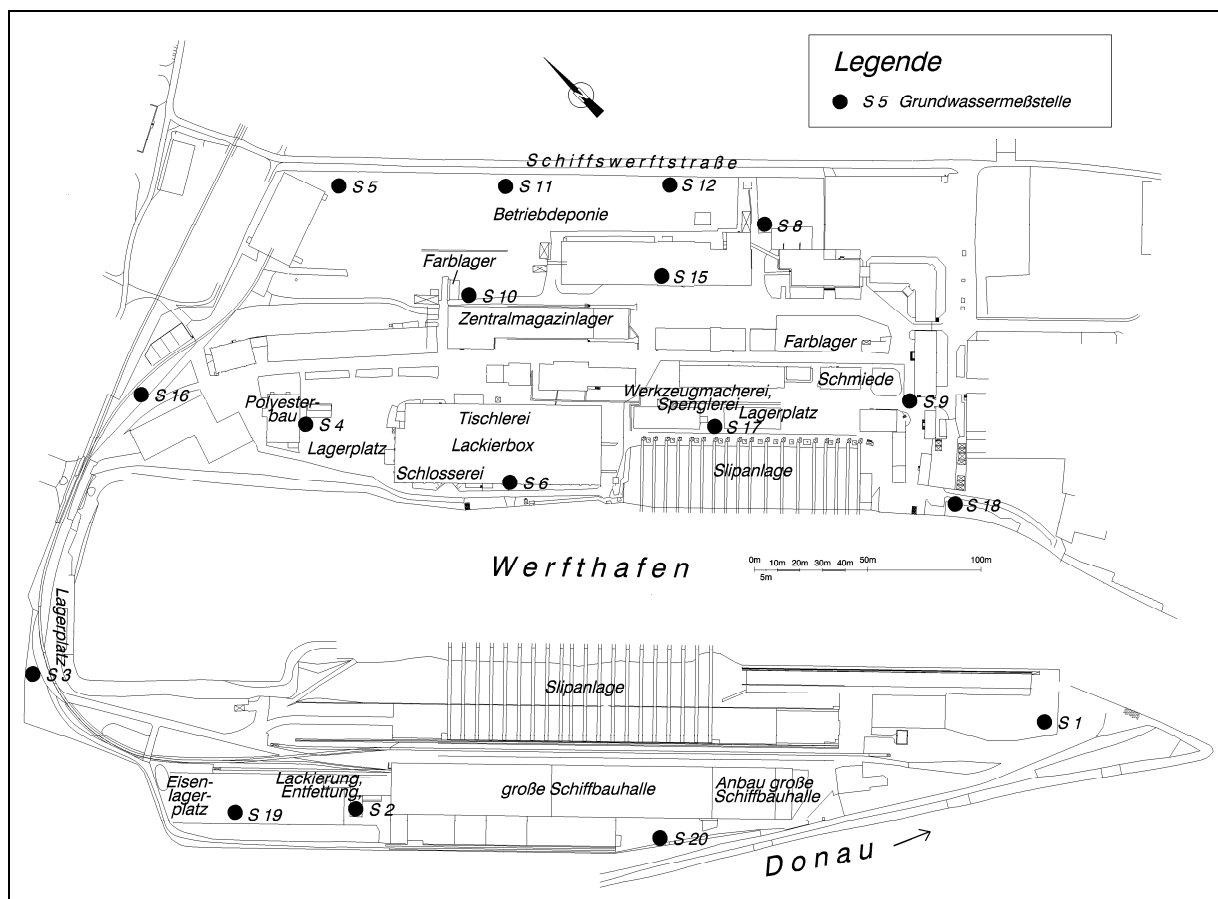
Lageplan der Werft Korneuburg (schematisch)
